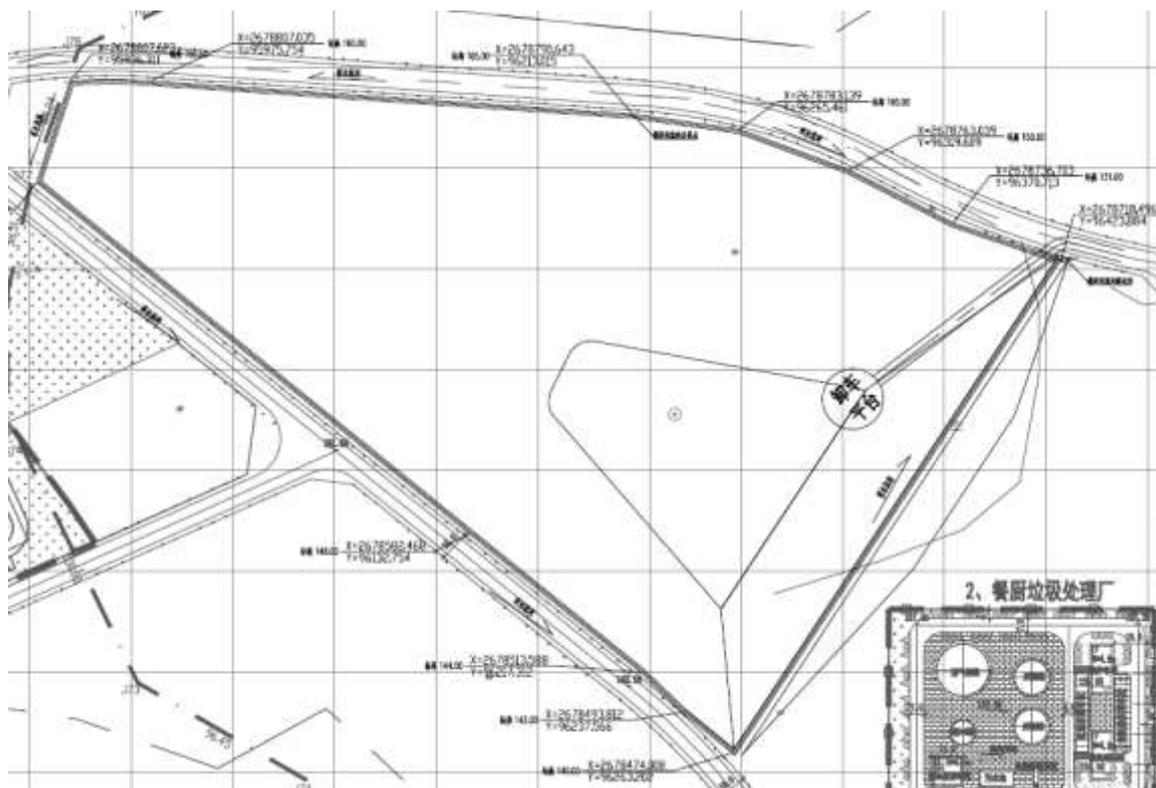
飞灰填埋区截洪沟平面布置图
